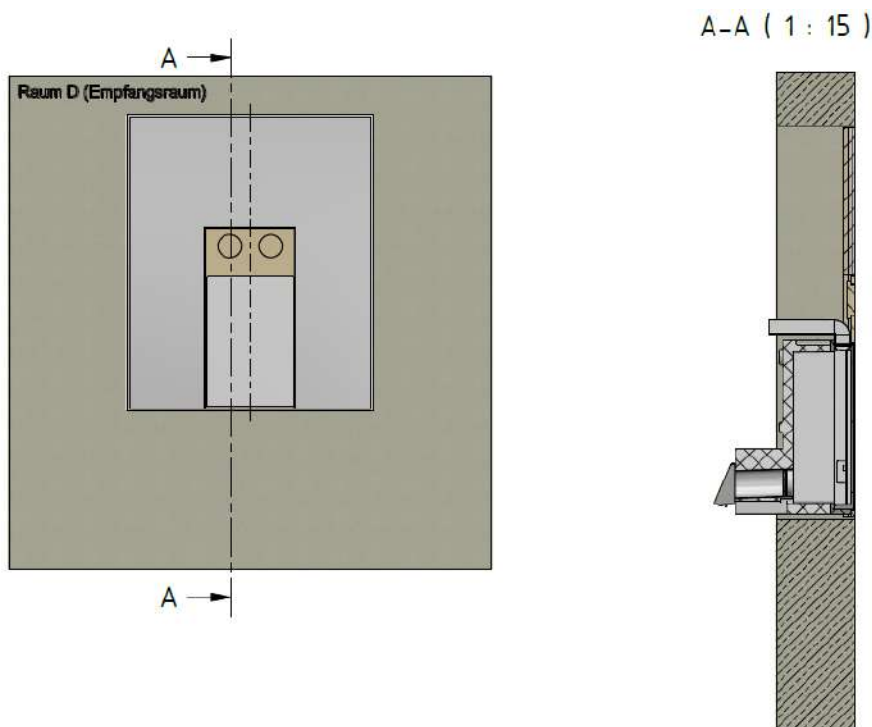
Prüfvariante mit Kanalanschluss ABL- und ZUL-seitig: Innenansicht und Vertikalschnitt des Prüfaufbaus.
